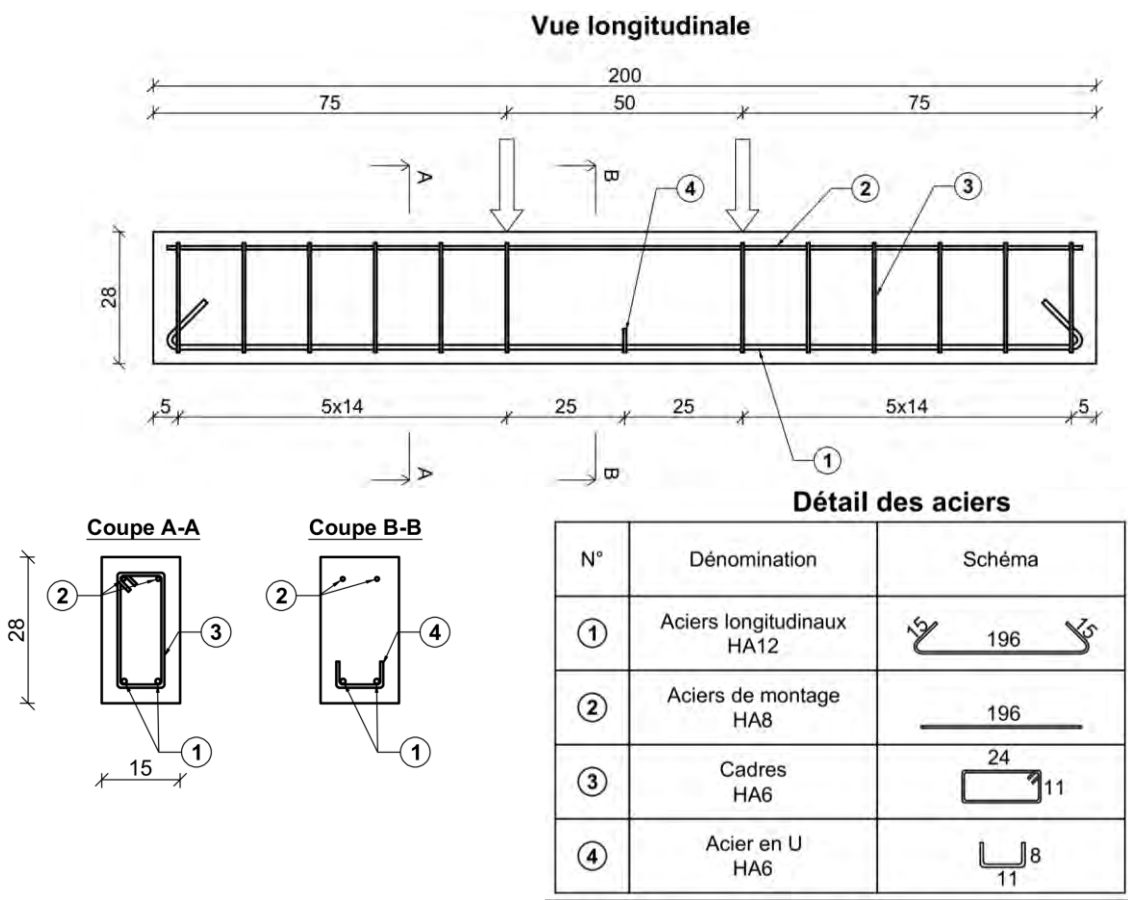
Plan de ferrailage de la configuration 2 (poutres P2 à P4)
